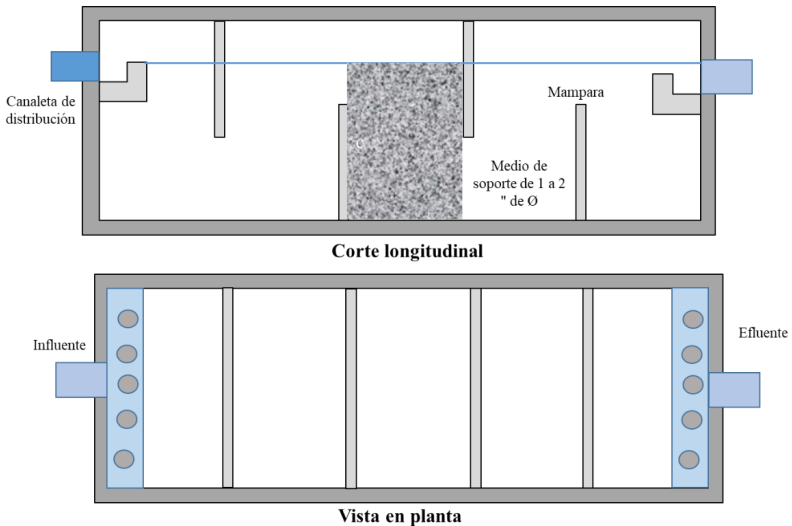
Corte longitudinal y vista en planta del FBAH.
